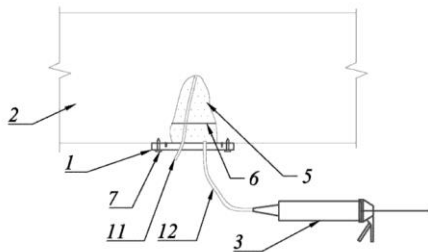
Схема подавання суміші в опалубку змонтовану на плоску конструкцію з глибокою порожниною: 1 – опалубка; 2 – залізобетонна конструкція; 3 – шприц для подачі суміші; 5 – ремонтна суміш; 6 – оголена арматура; 7 – анкерне кріплення; 11 – гнучка трубка для випускання повітря; 12 – гумовий шланг
